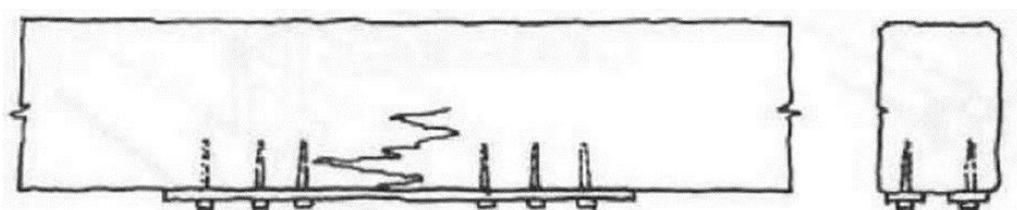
Reforço de viga através da colocação de chapa metálica na face inferior
